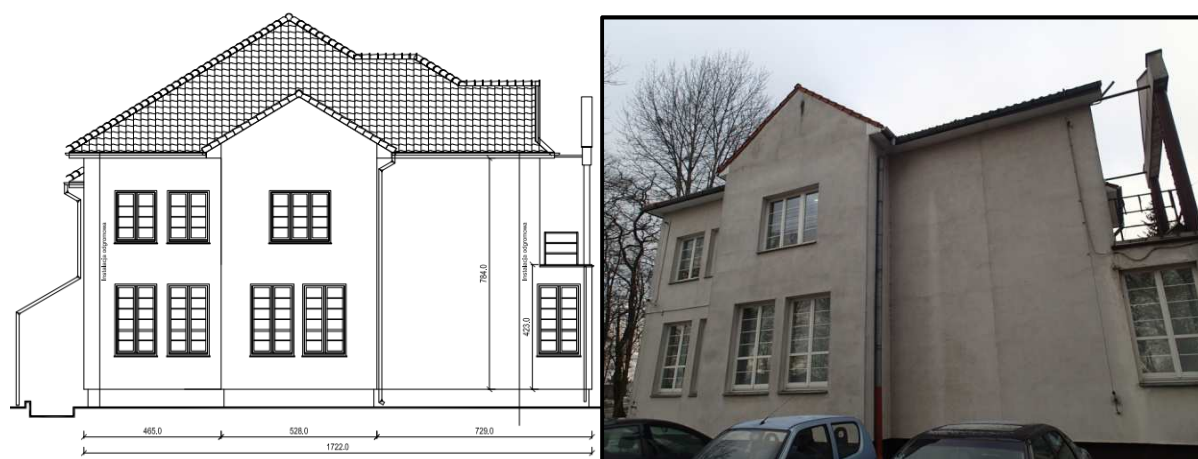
Elewacja frontowa - strona północna budynku. Po lewej stronie widok na część dobudowaną z balkonem.
